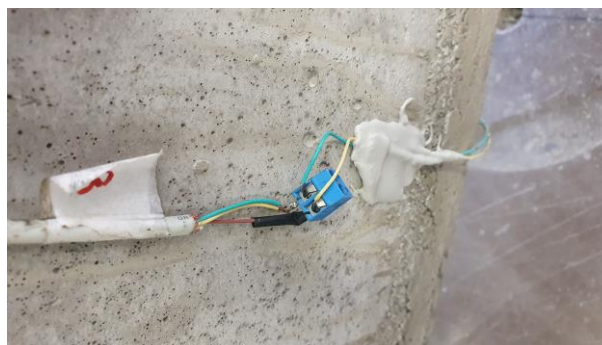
Proteção da instalação do extensômetro fixado ao têxtil (Fonte: Autor)
